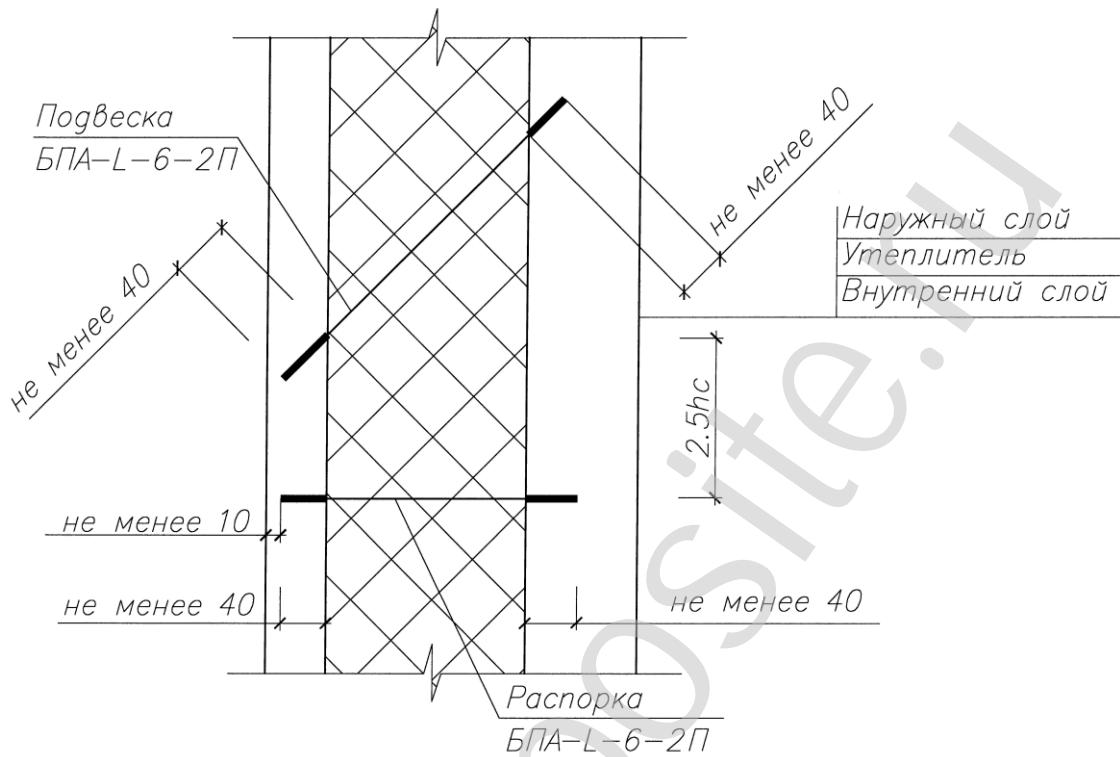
Трехслойная железобетонная панель. Вертикальный разрез.
